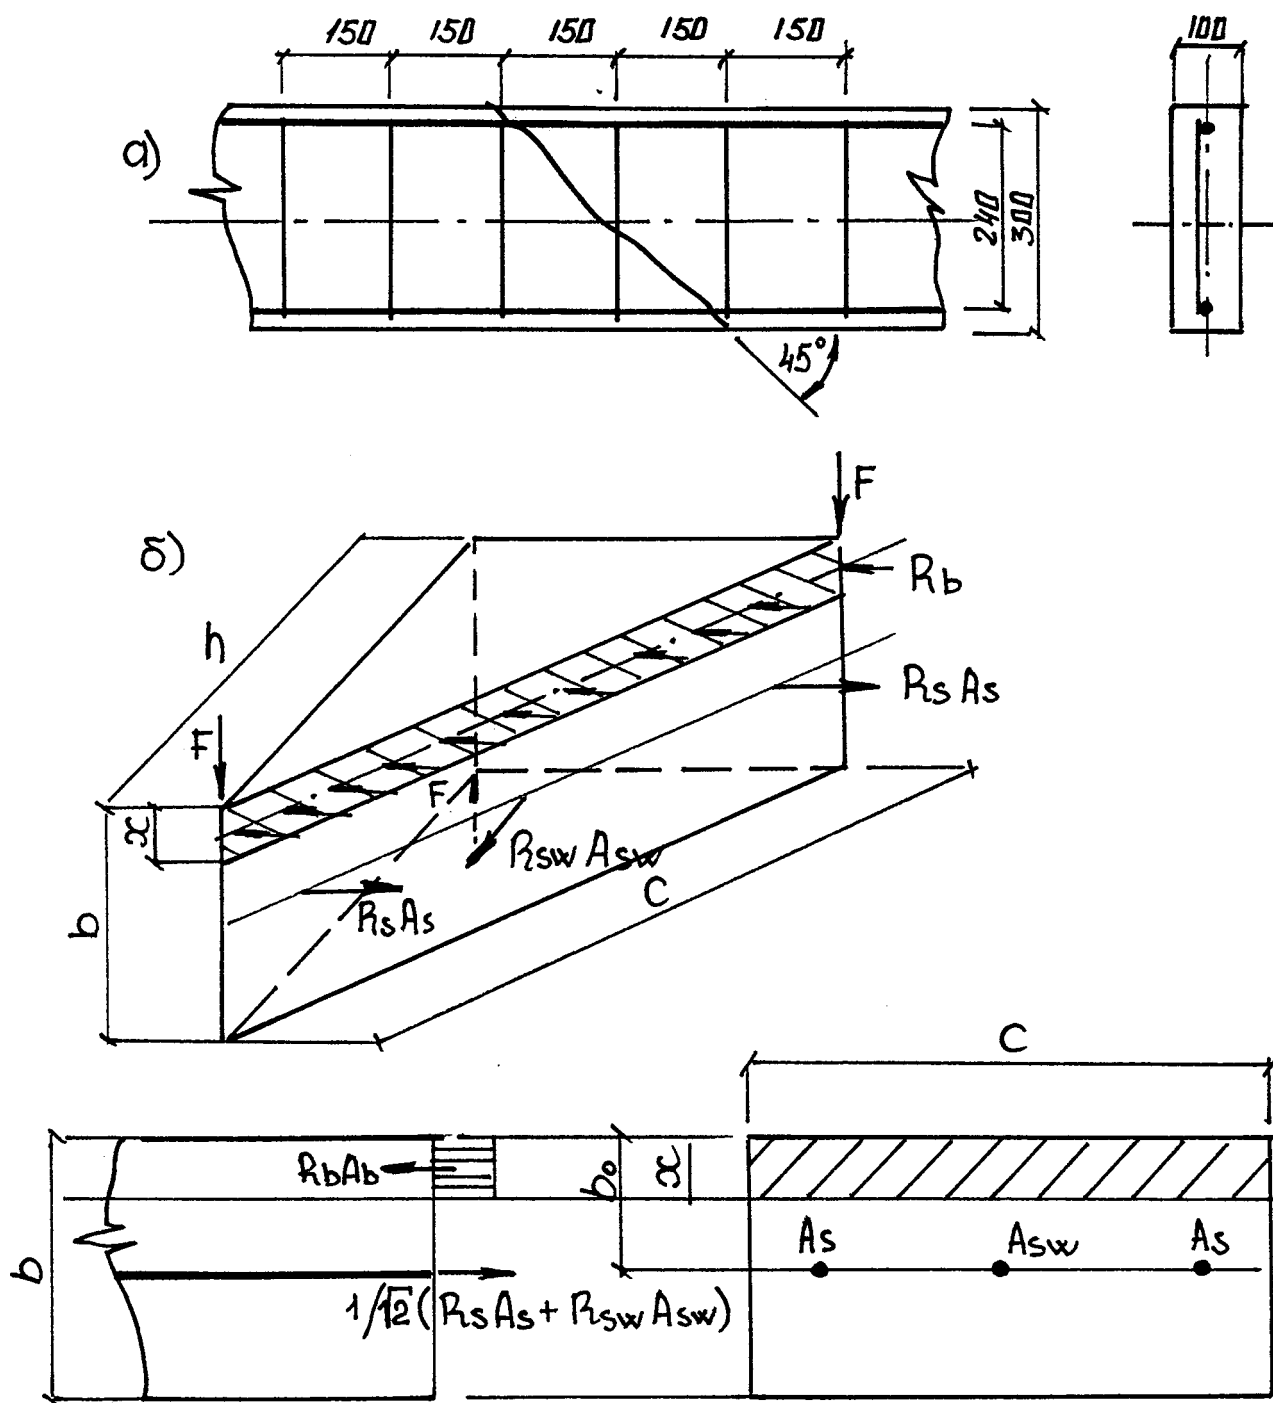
Схема расположения опасного сечения в железобетонном образце (а); расчетная схема железобетонного элемента (б)
